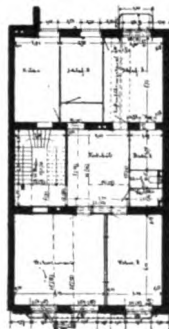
Alleestrasse 30. 1. Obergeschoss. 1:500.
